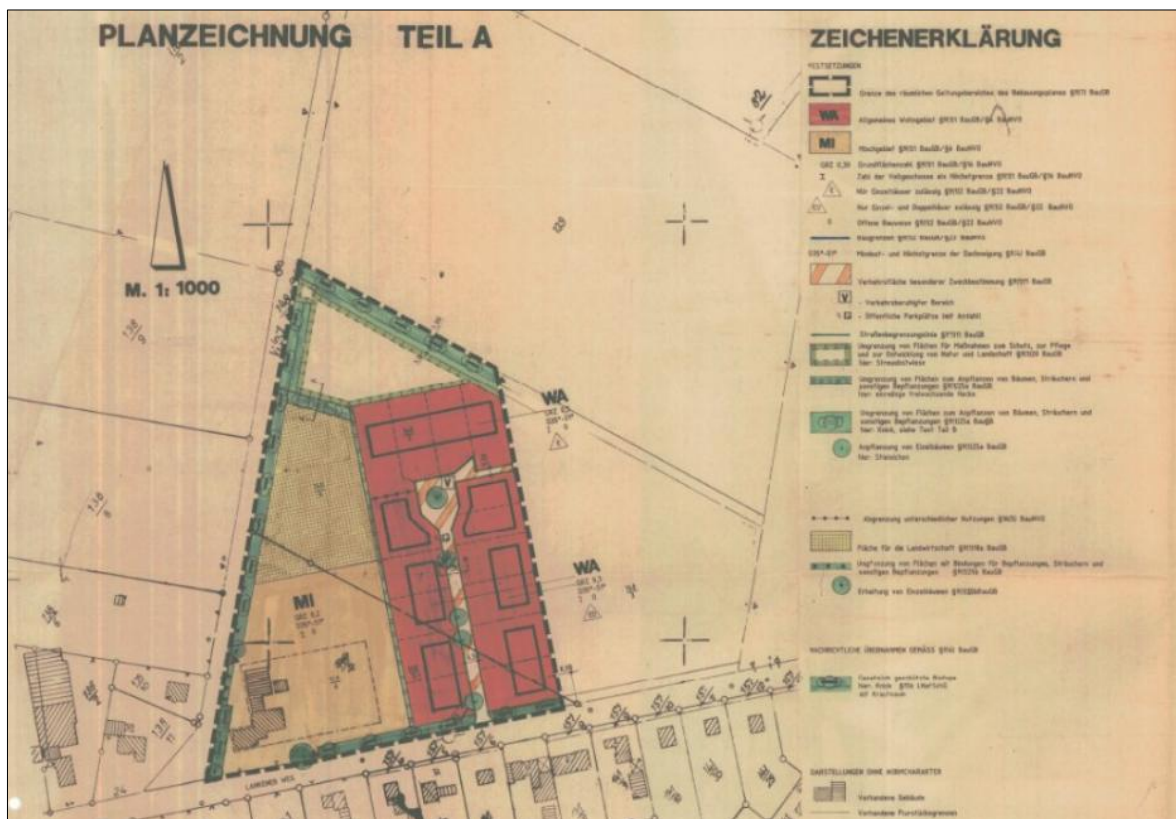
Ausschnitt B-Plan Nr. 7, Gemeinde Elmenhorst
